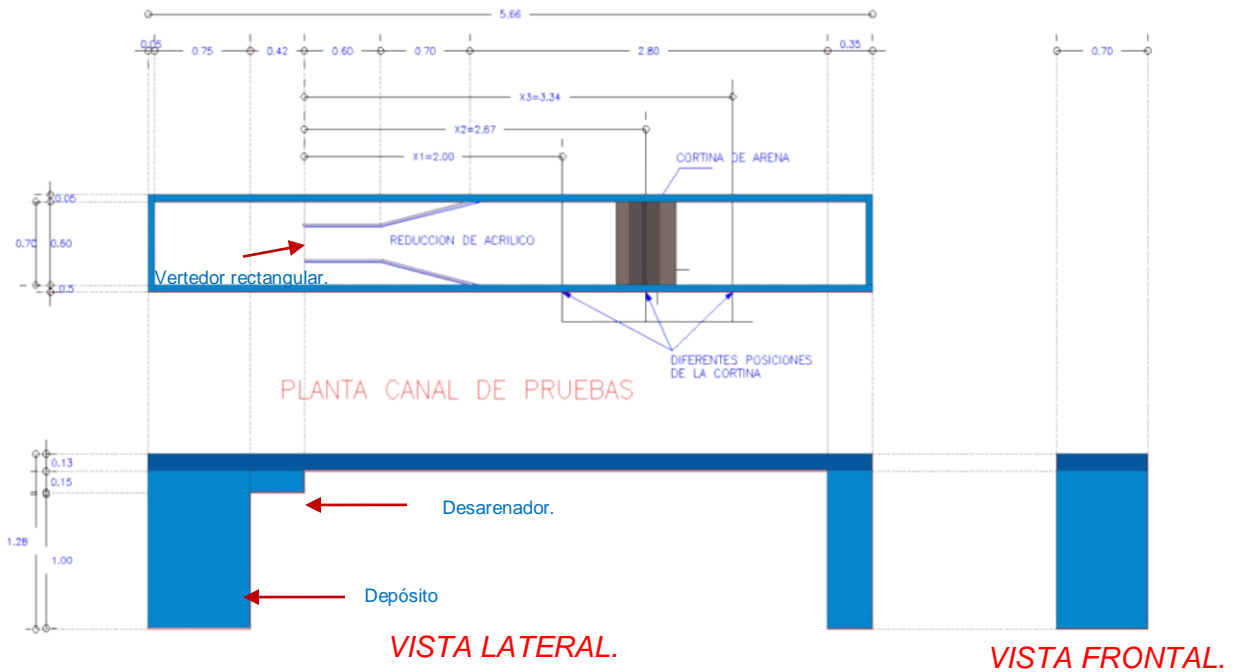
Planta arquitectónica, vista lateral y frontal del canal de pruebas.
